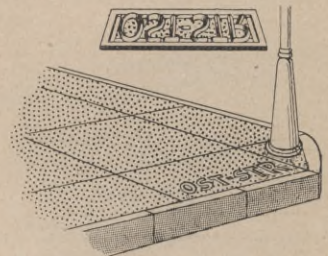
Beton-Prägeform z. Einprägen des Straßennamens in die Straßensfläche.
